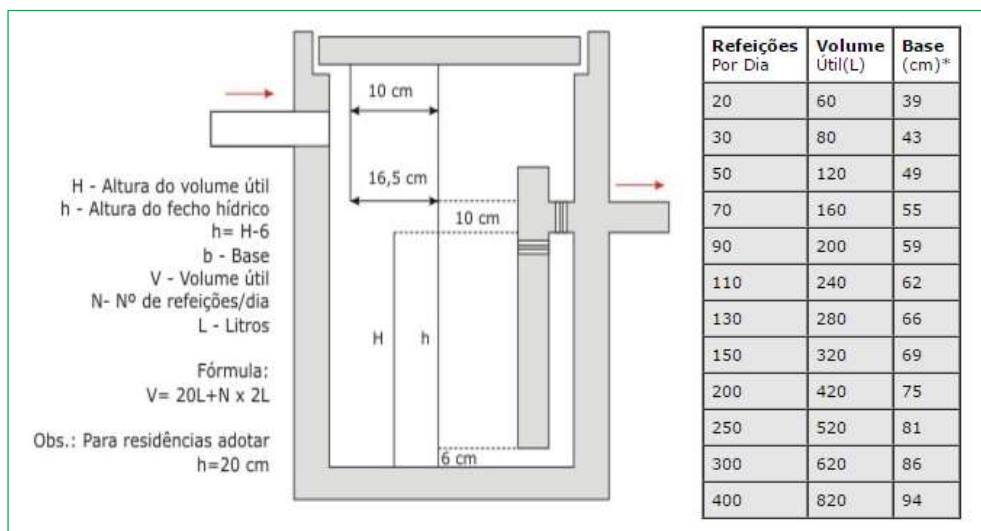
Detalhe Caixa de Gordura e dimensionamento.
